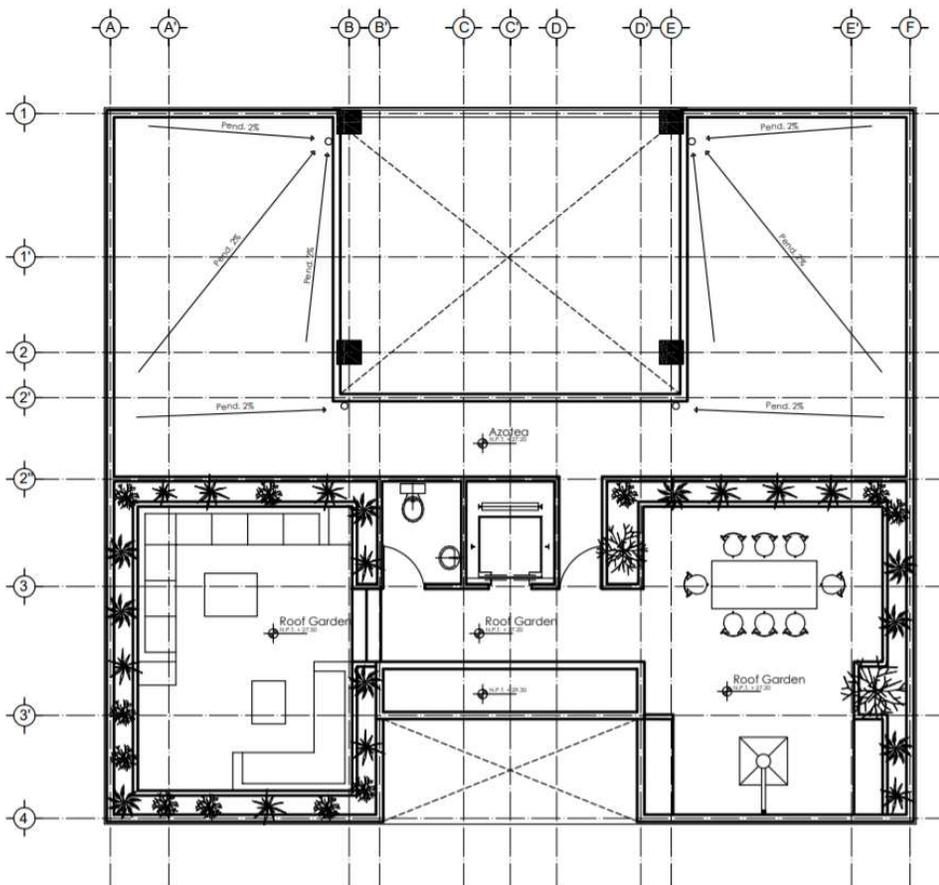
Planta de Azotea habitable, sexta hipótesis
